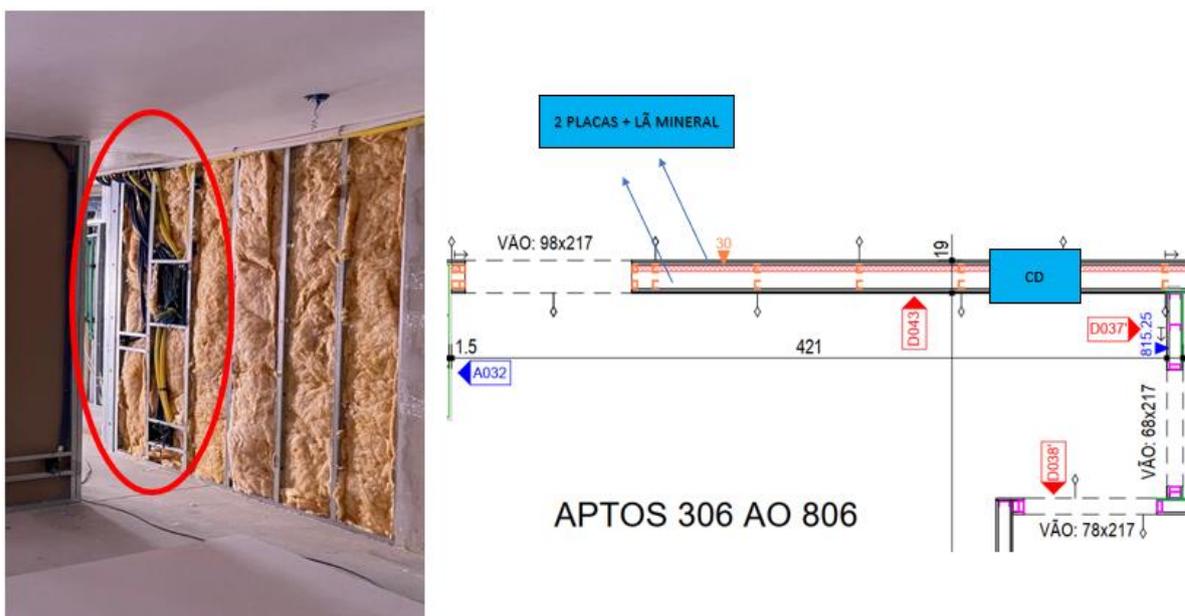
Estrutura da divisória dos finais 06 e 04 sem viga na parte superior
